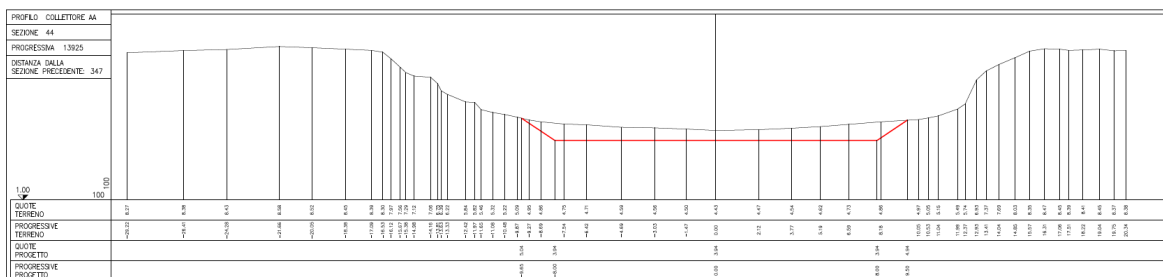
Sezione trasversale di scavo esempio del tratto intermedio (sez 44).
